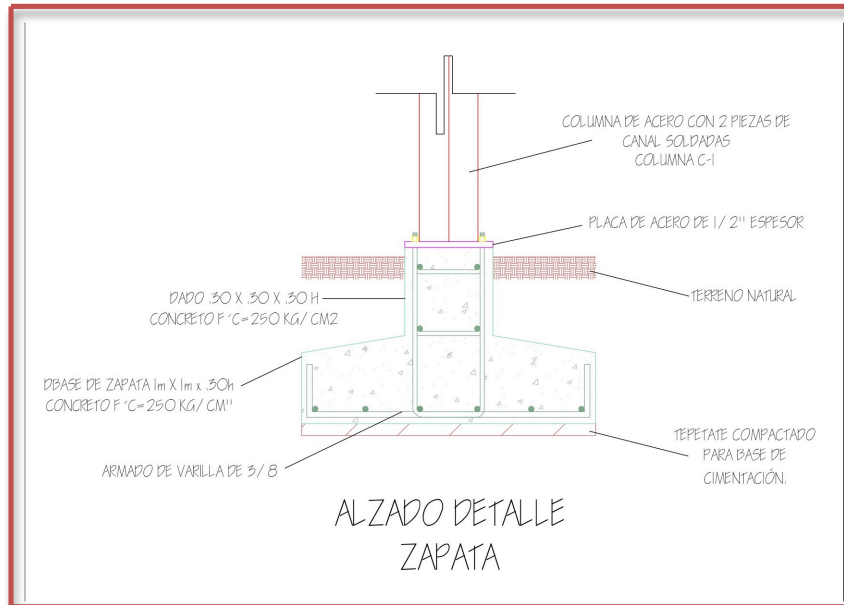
Zapata aislada y anclaje de columna con 2 piezas de canal de acero propuesta por: Juan Ramírez..
